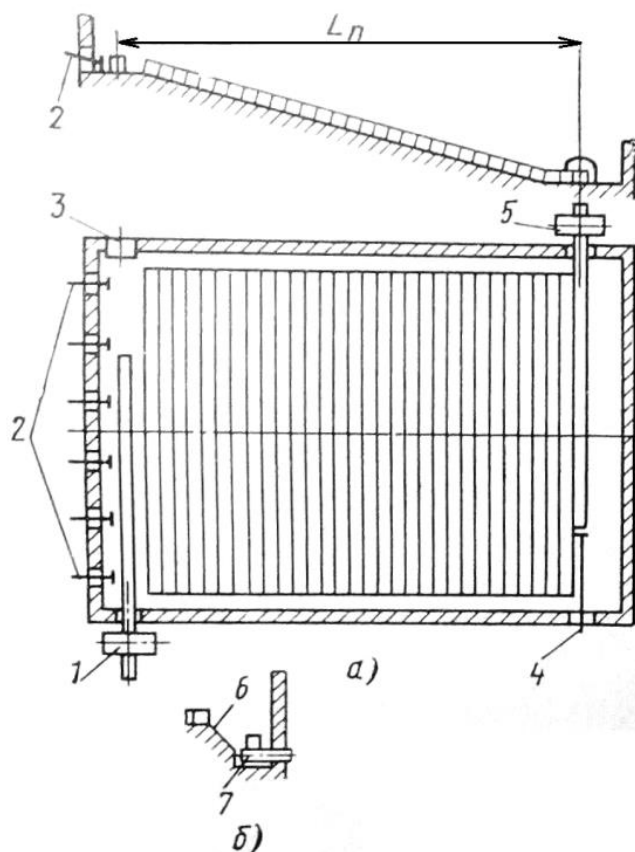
Схема транспортирования с боковой загрузкой и боковой выдачей
